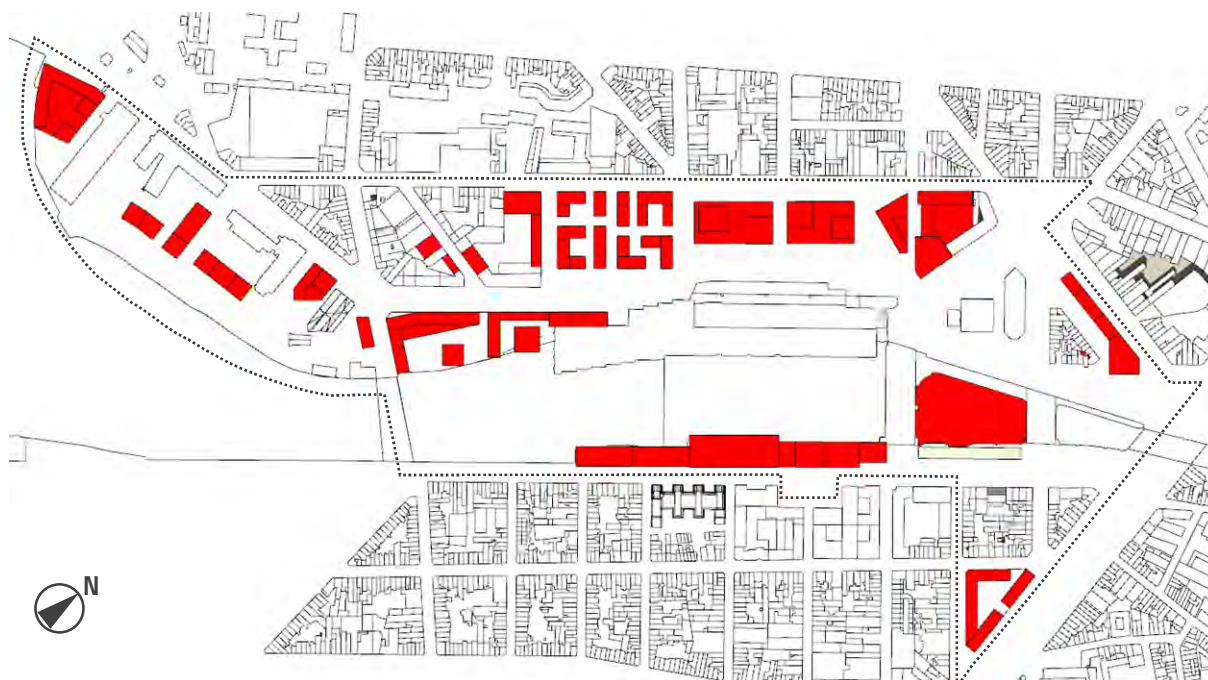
Plan de l'alternative projet 2018 (en rouge, les constructions nouvelles)
